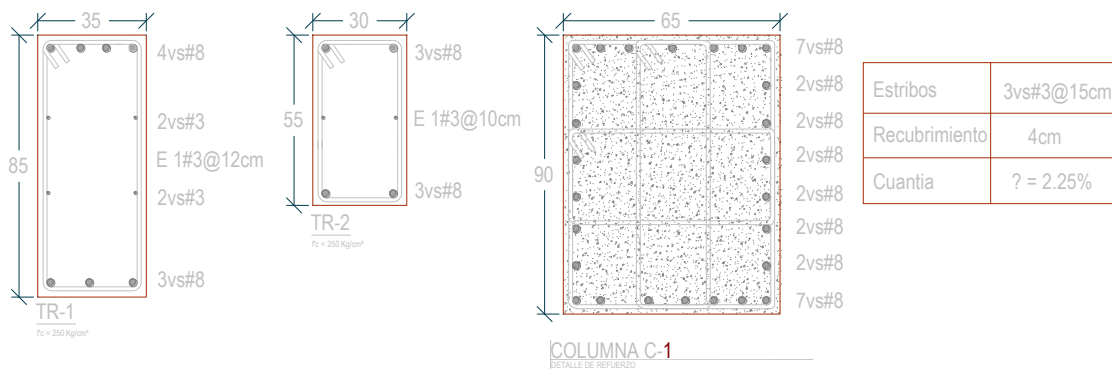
Secciones transversales de edificios diseñados con NTCC-20 (con interacción suelo-estructura y con base fija)
